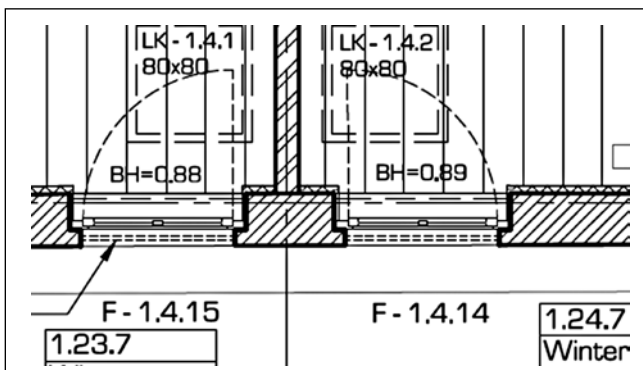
Ausschnitt Wandanschluss einer neuen Innenwand (d=15 cm, Trockenbau) an Bestands-Außenwand (d=30 cm); Ausschnitt aus dem Grundriss DG, Achse H-9 vom 29.08.2011 vom Architekturbüro raumwandler.de
